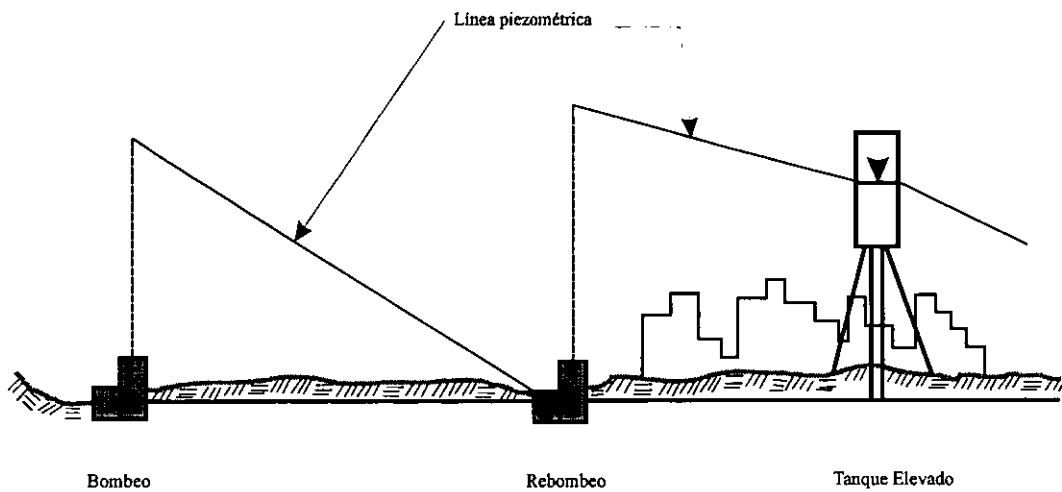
Tanque elevado al centro de la localidad, (no recomendable).
